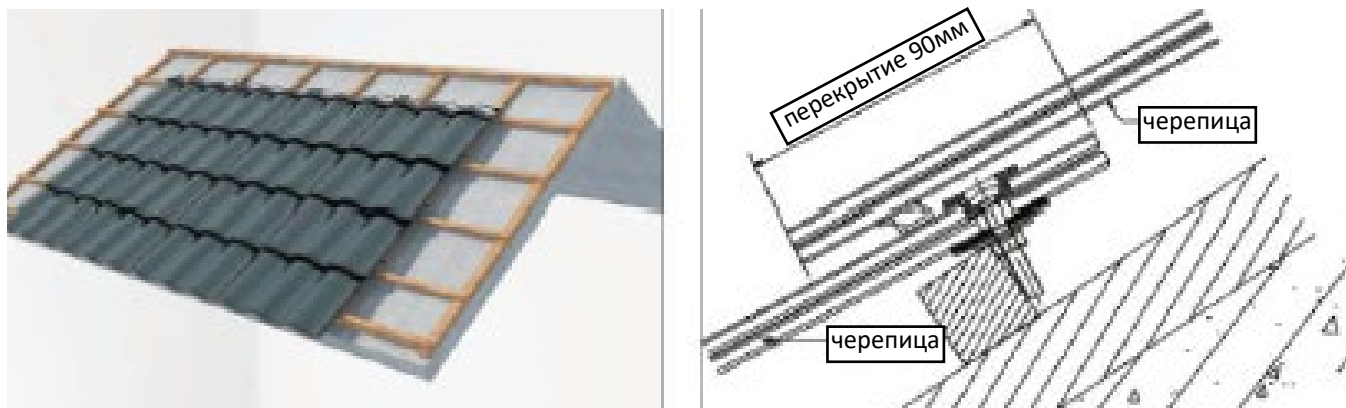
Установка солнечной черепицы на бетонной крыше
